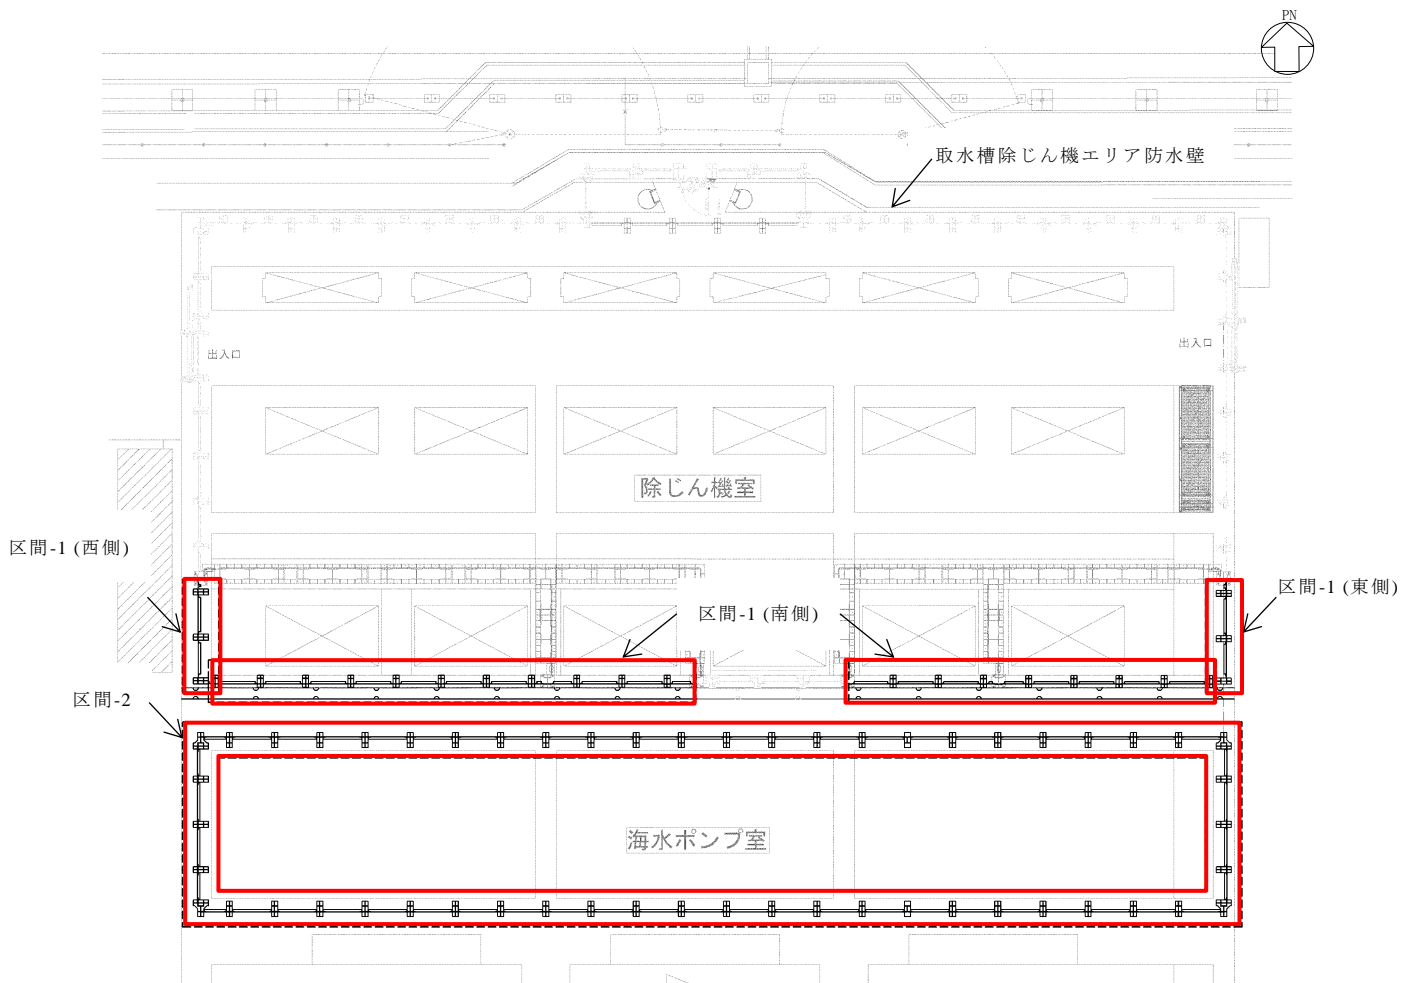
取水槽海水ポンプエリア防水壁の配置図
